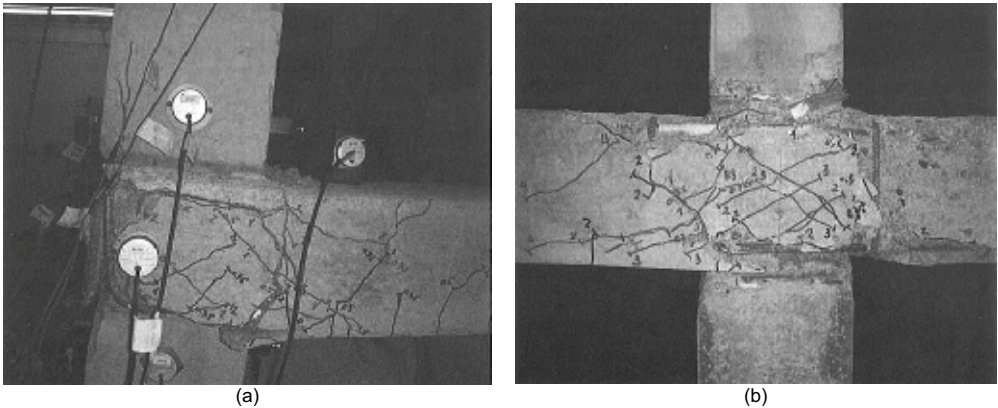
Fallo de conexión. (a) Viga plana-pilar exterior. (b) Viga plana-pilar interior. (Fuente: Benavent-Climent, 2010)
